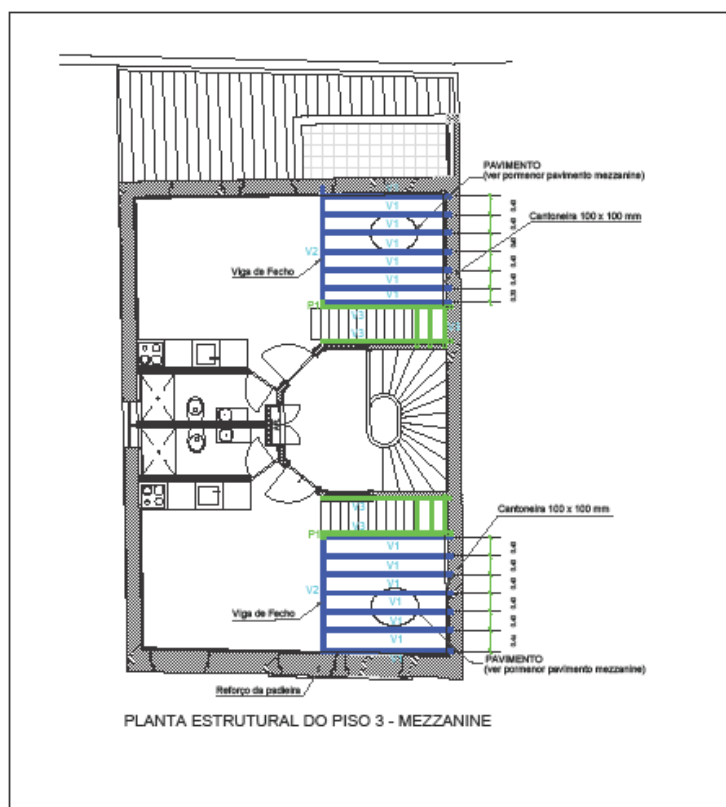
Planta estrutural do Piso 3 - Mezzanine
